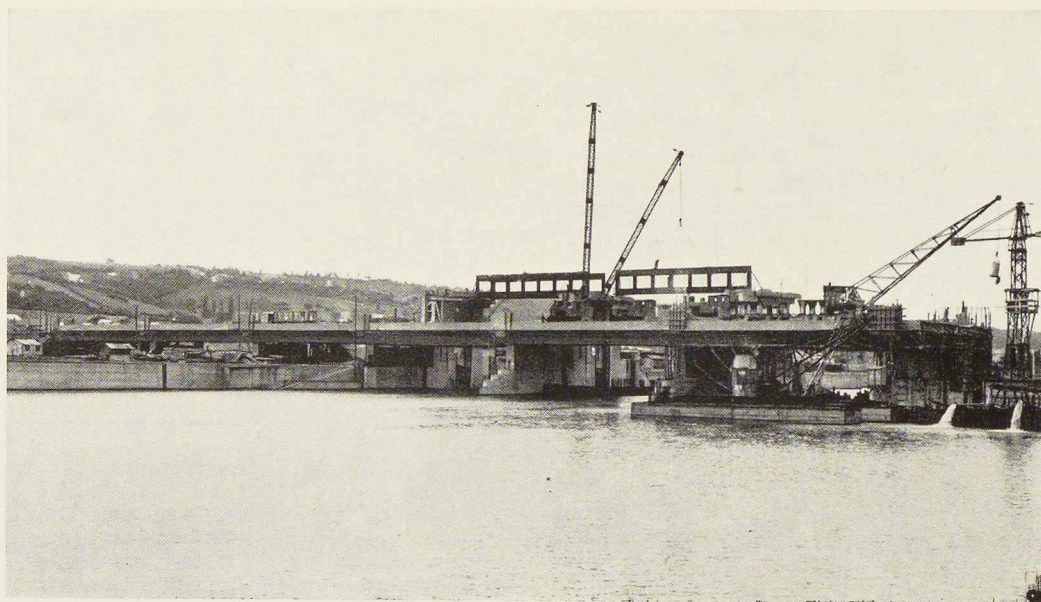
Vue générale du barrage de Ramet-Ivoz, en construction.
